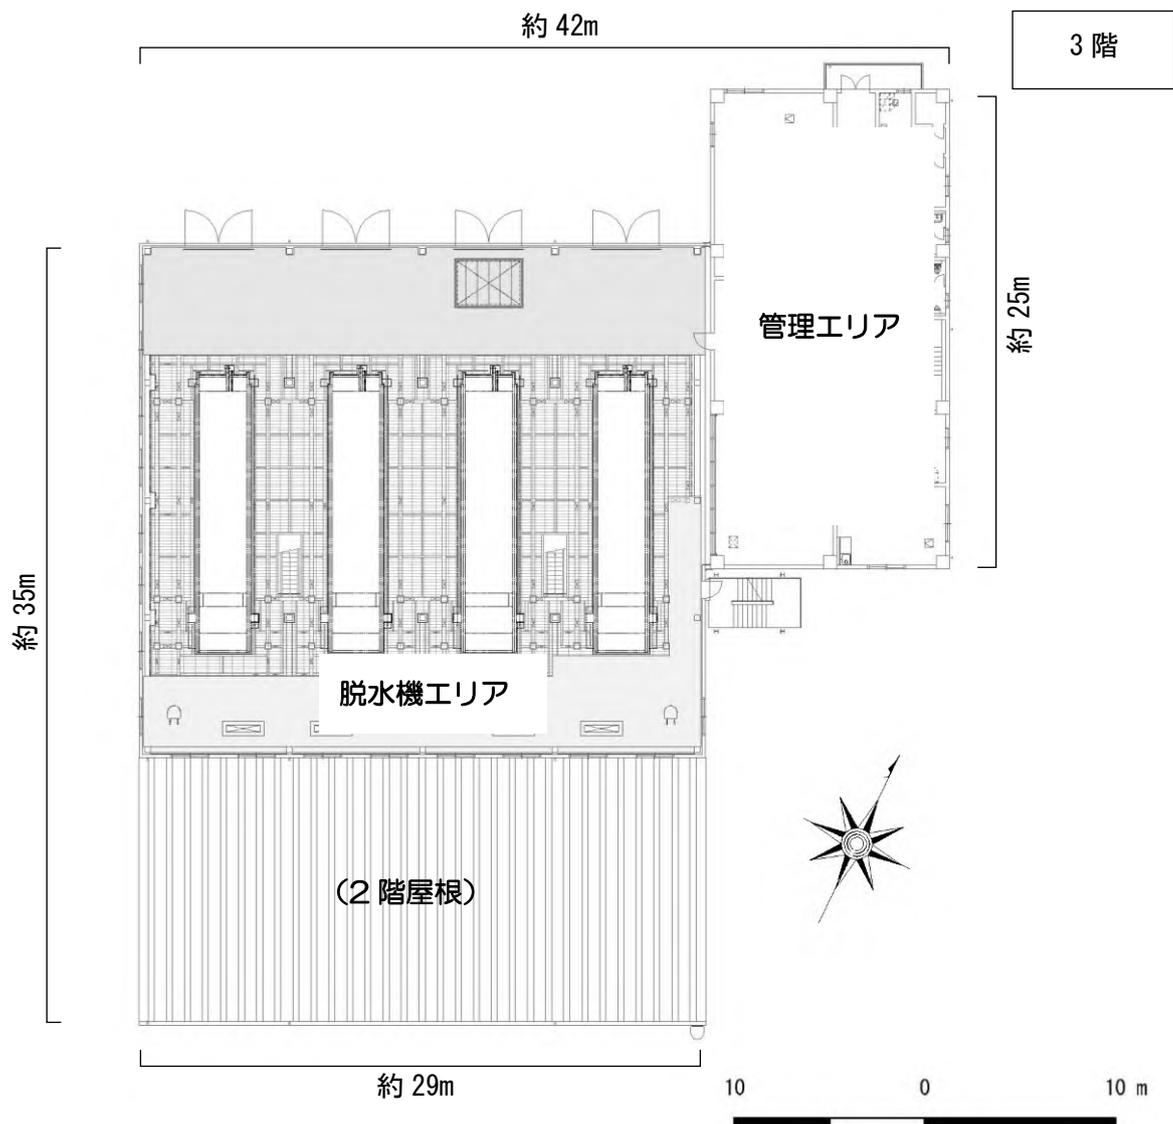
(3) 3階平面図 (縮尺 1:400)
